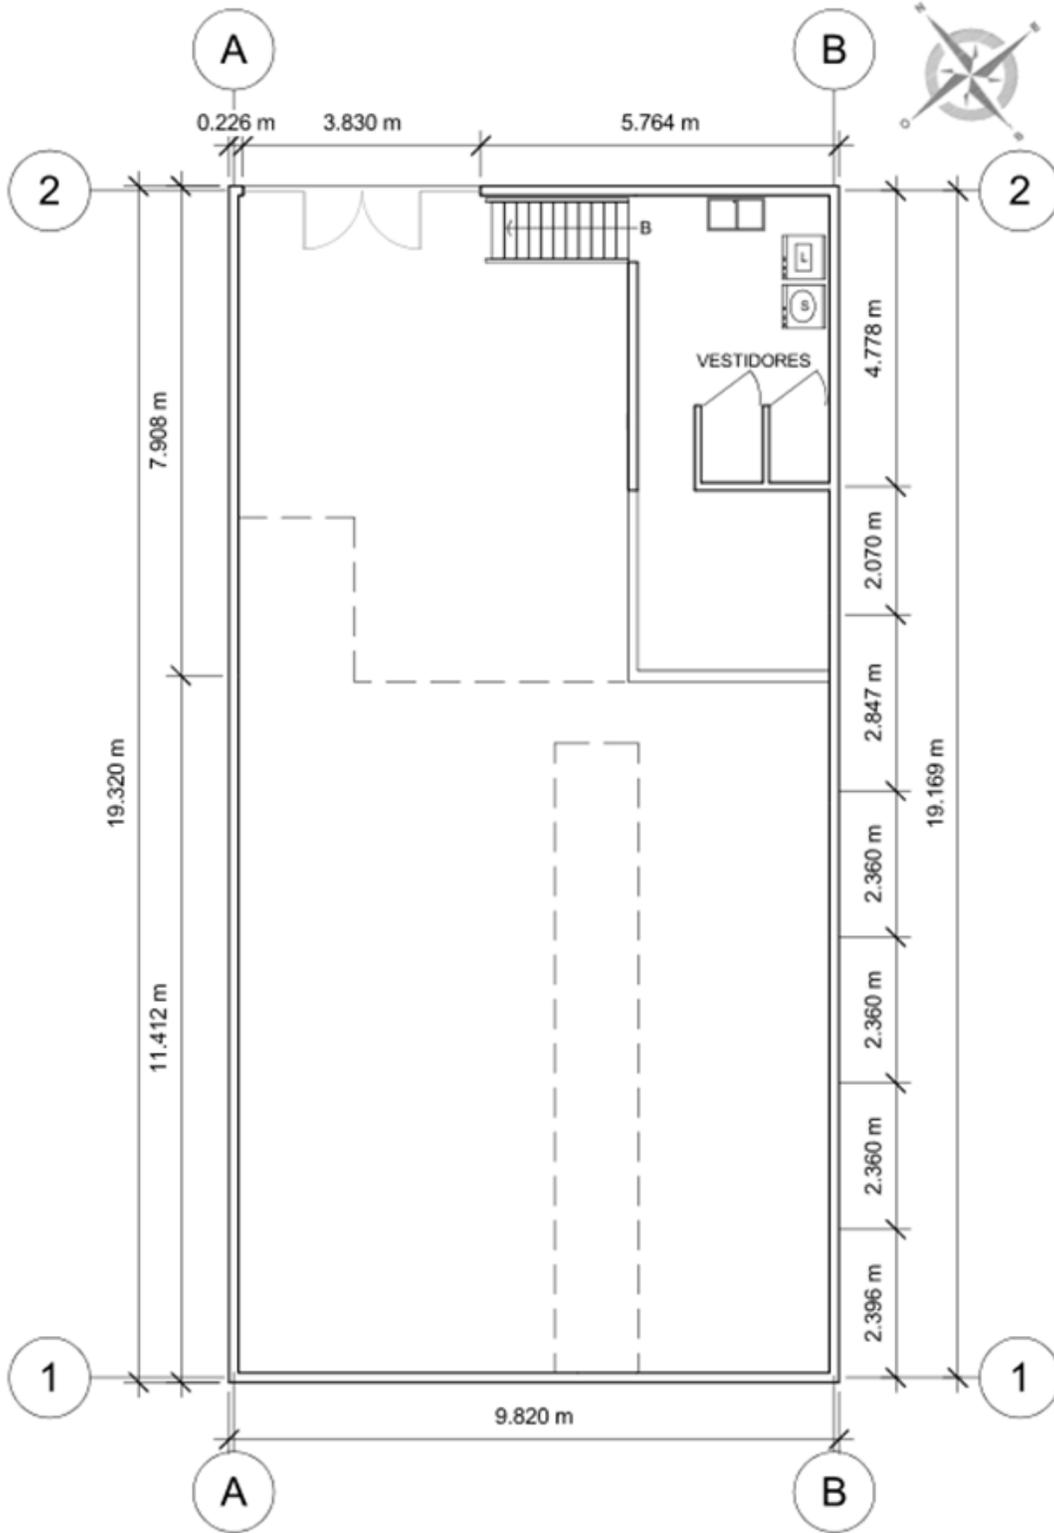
Planta amueblada UNAERC, fuente: Elaboración propia
